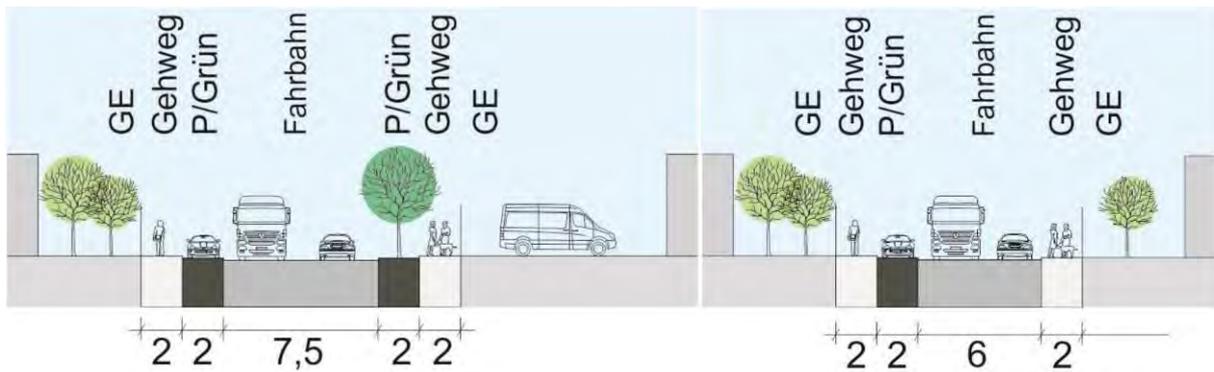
Systemschnitte durch Planstraße A (links) und Planstraßen B und C (rechts) (unmaßstäblich)
